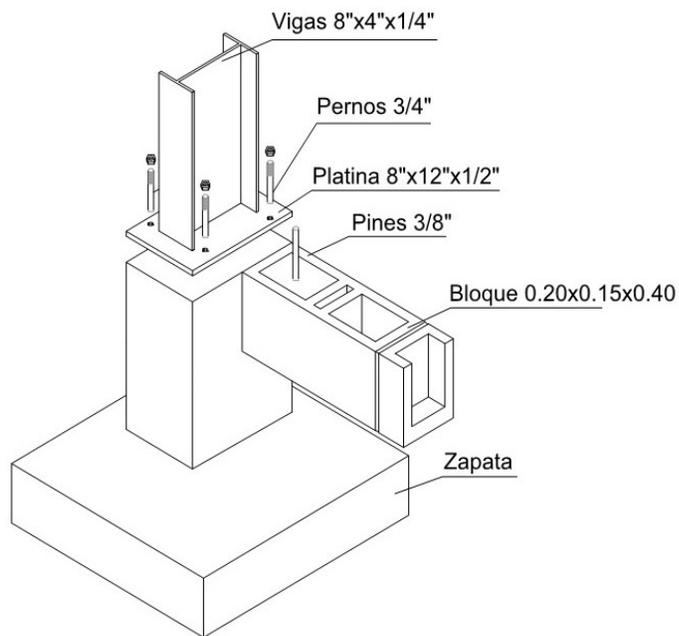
Detalle de estructura metálica / Fuente: Elaboración modificada de Bibliocad
